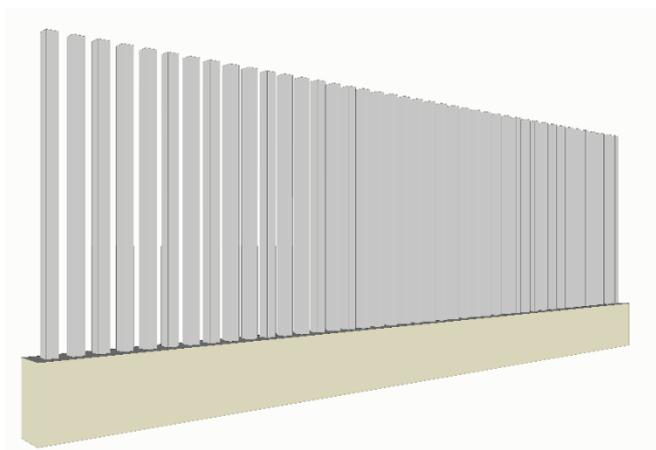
Vista prospettica della recinzione della Stazione utente di trasformazione
